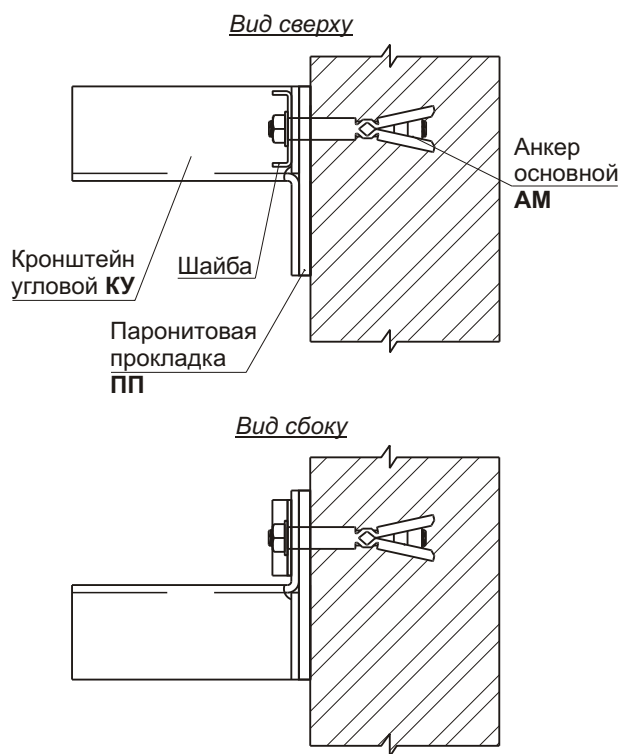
Крепление кронштейна КУ к стене одним основным анкером
